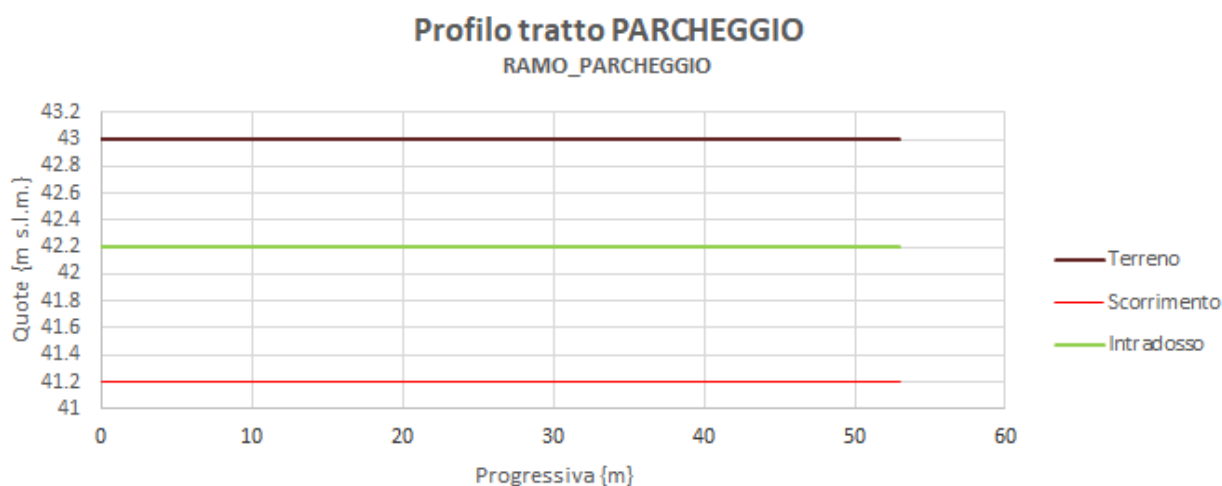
Profilo longitudinale tratto PARCHEGGIO
